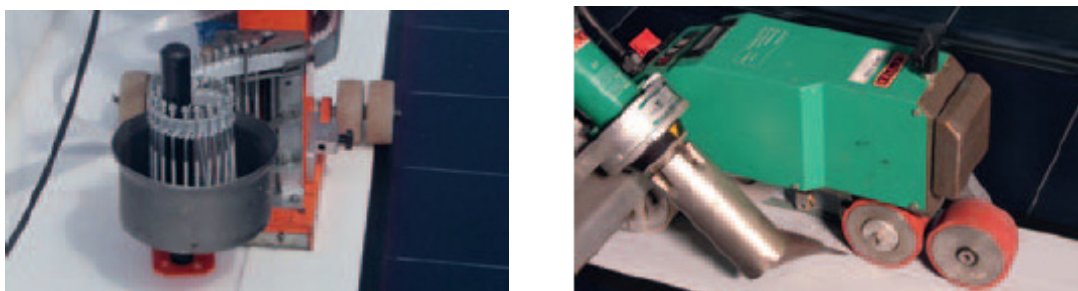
Fixation mécanique des membranes et soudage à air chaud
